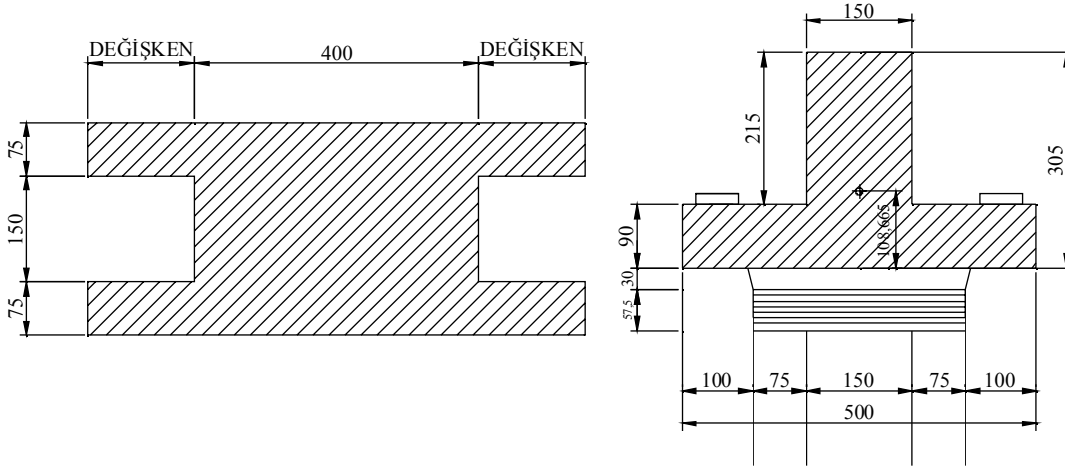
Öngerilmeli kirişlerin üzerine kalıp plaklarının oturması
